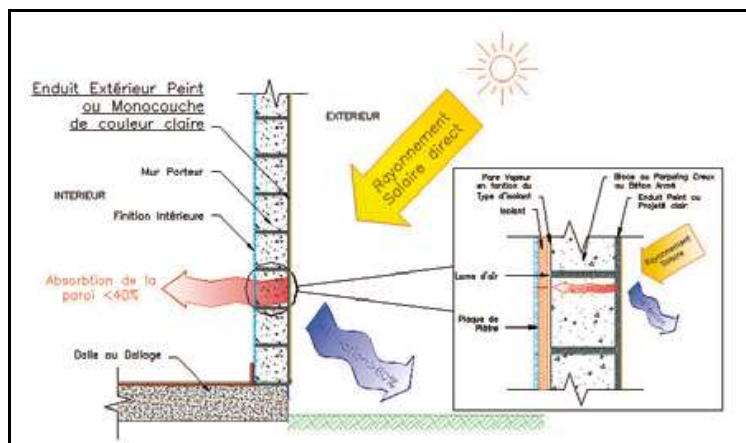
rayonnement solaire sur paroi et absorption, cas de l'enduit extérieur type monocouche peint
